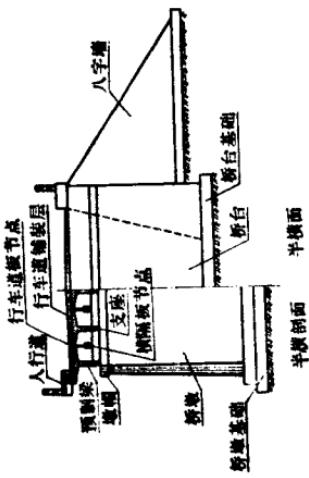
乙 装配式钢筋混凝土梁桥的一般构造(半横剖面、断面)
